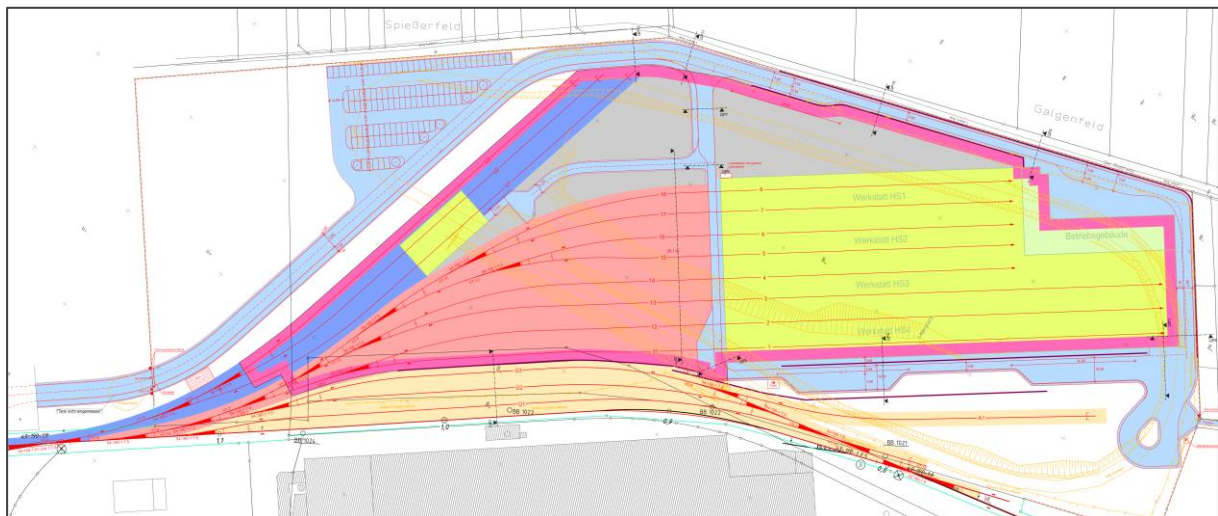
Übersichtslageplan mit Gebäuden, Gleisen und Verkehrsflächen
